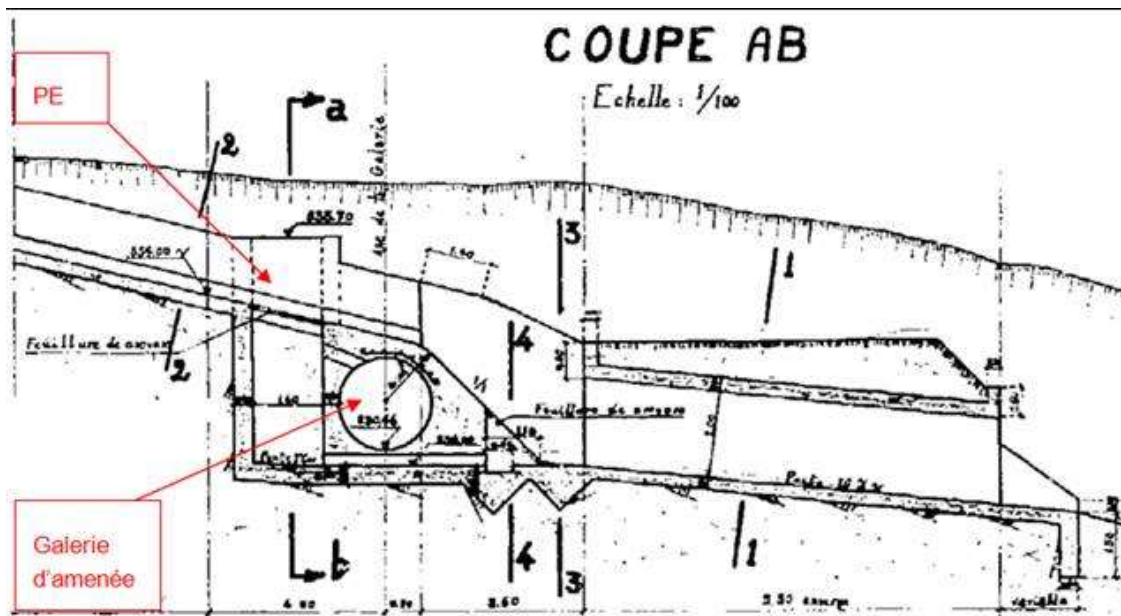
Prise d'eau de Domec – Coupe longitudinale
